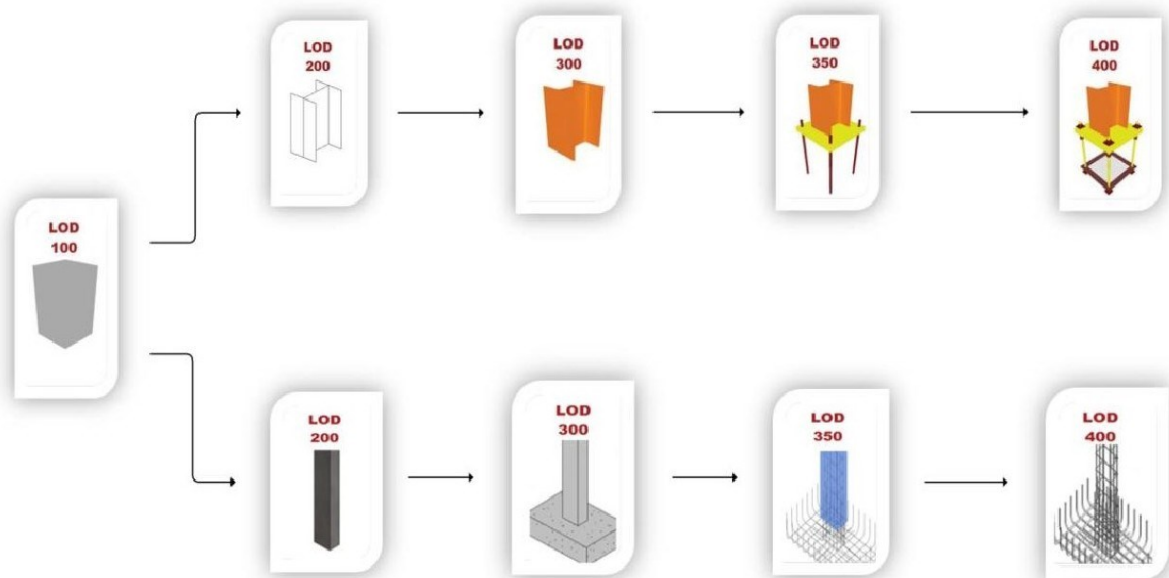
Etapas de LOD para estrutura metálica e concreto armado
